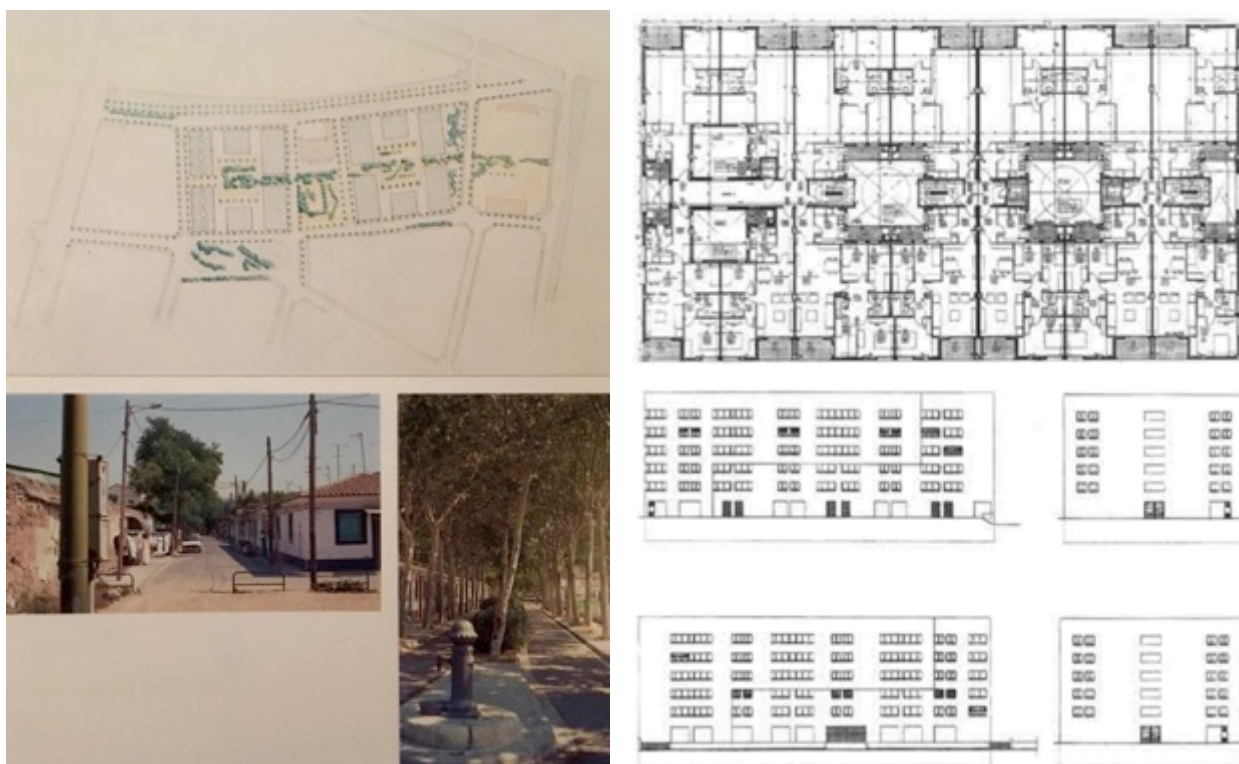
(Izq.) Jordi Santamaría (s.f.). Propuesta original para el proyecto de remodelación del espacio público. Fuente: *Barcelona: La segona renovació* (1996). (Der.) J. Llusà y D. Ferrer, proyecto (1988), construcción (1991). Plantas y alzados de bloques de vivienda Eduardo Aunós (tipo I y II, primera fase de sustitución). Fuente: Archivo PMH, en: Morales, 2015.
